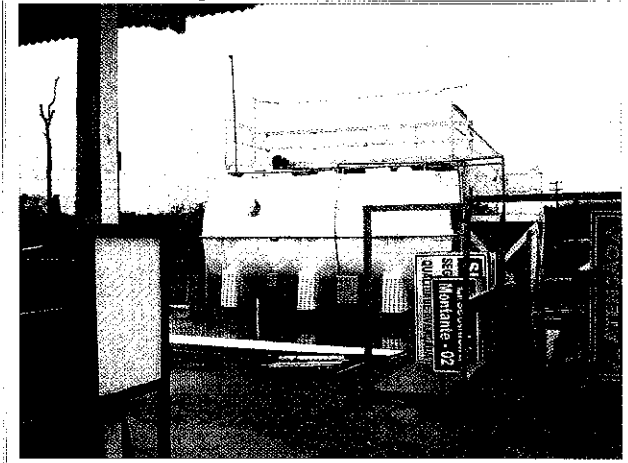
Estação de Tratamento de Esgoto compacta localizada no canteiro de obras.
